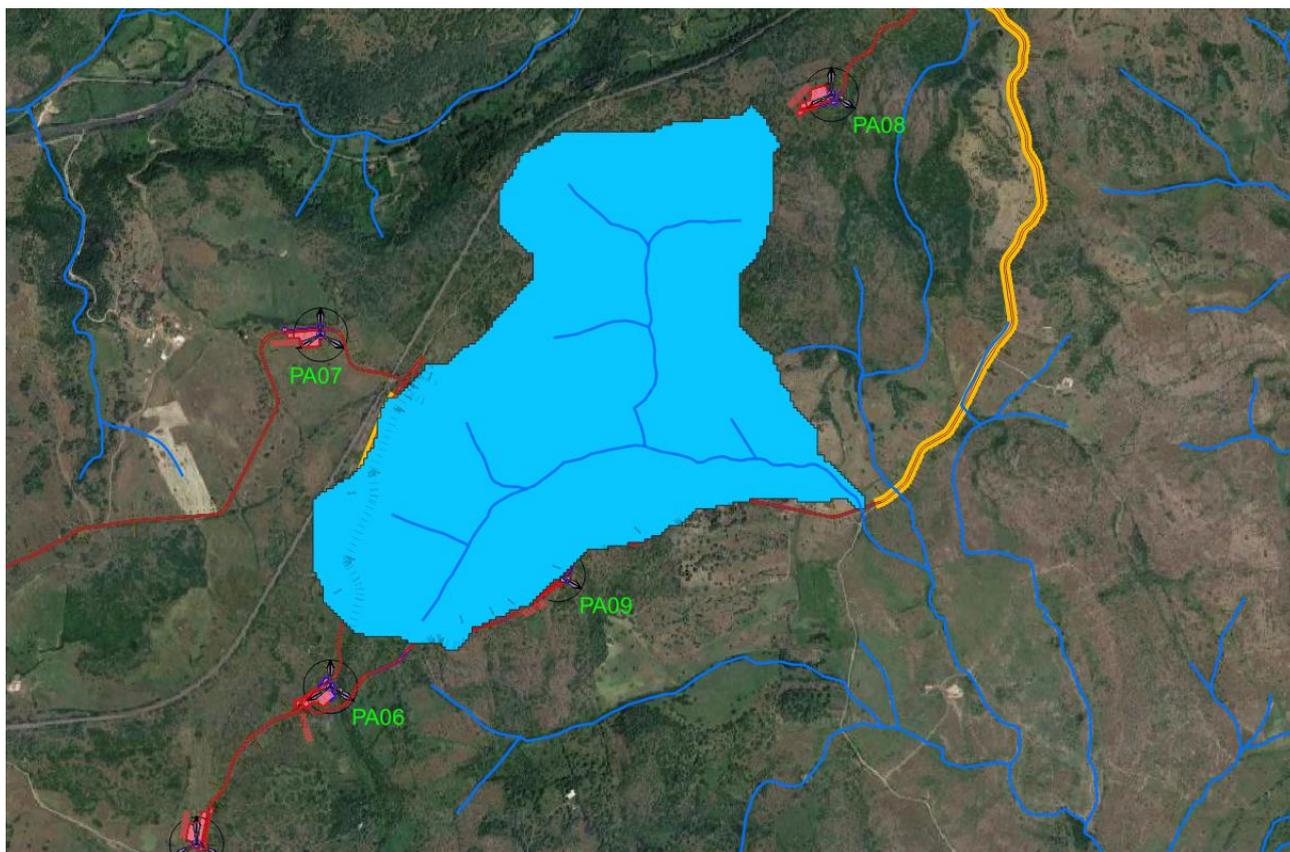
Planimetria con individuazione del bacino idrografico dell'attraversamento 4
